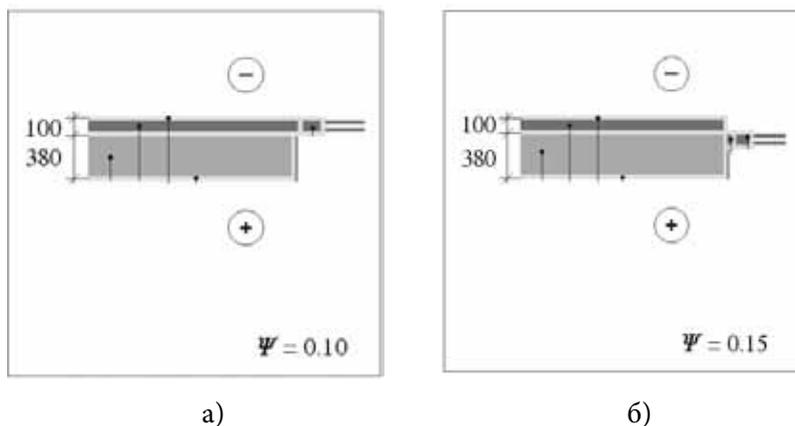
Установка окна непосредственно в наружном слое теплоизоляции (а) и перед слоем наружной теплоизоляции (б).
